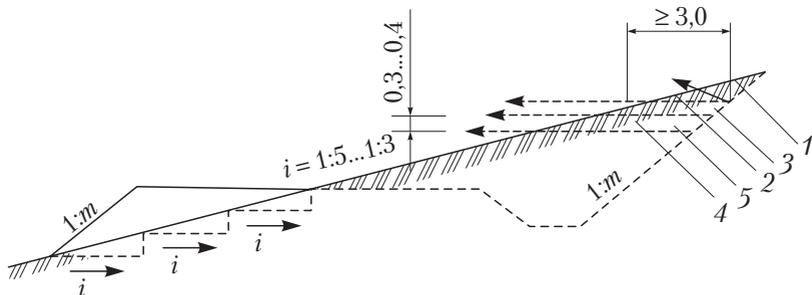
Разработка грунта на косогоре (1–5 – последовательность снятия слоев грунта)
